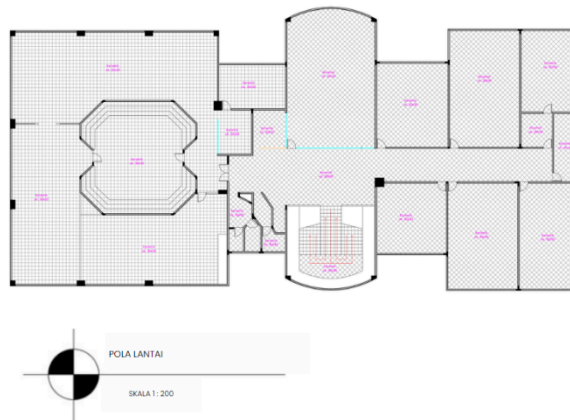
Layout Existing Gedung T3 Lantai 3 Seni Rupa UNESA
